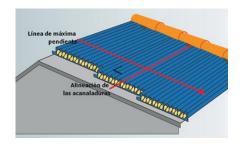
Colocación del aislamiento entre los tabiques palomeros de la cubierta.Fuente: Álvaro Pimentel.ATEPA
